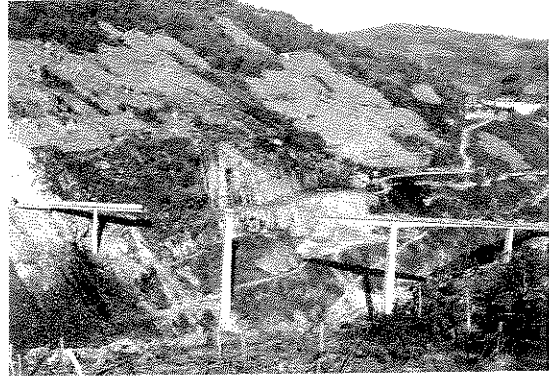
Puente de Chantada. Fase intermedia de construcción.
